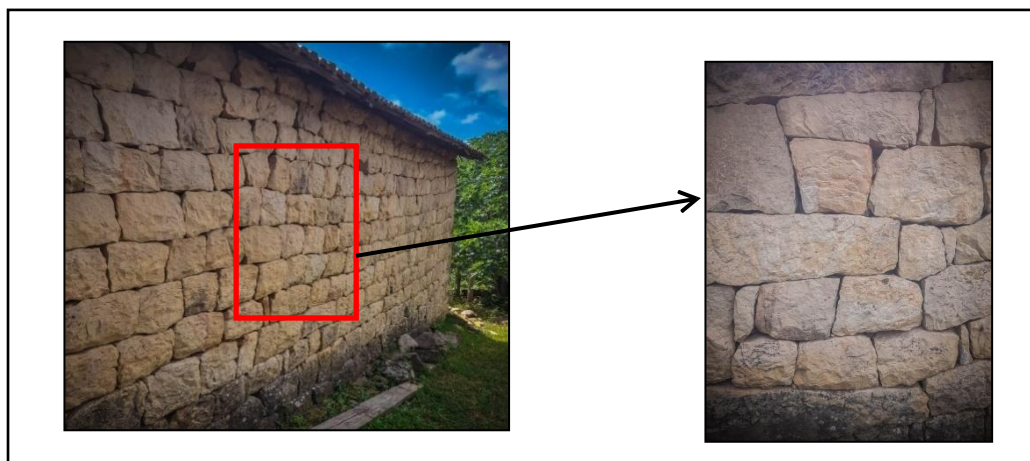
techniques constructives en pierre assemblées sec au sein du village Iguersafene
